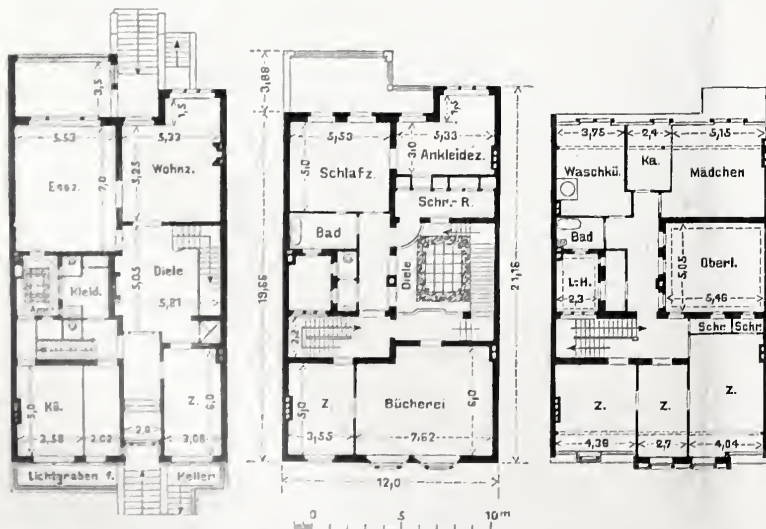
Erdgeschoß. Abb. 4. Erstes Obergeschoß. Abb. 5. Dachgeschoß.
